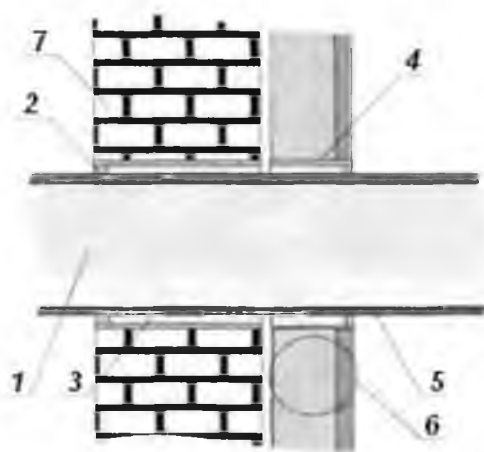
Ділянки з жорсткими повітропроводами: 1 – вентиляційний канал; 2 – віброакустичний силіконовий герметик; 3 – негорюча пружна прокладка; 4 – гільза; 5 – віброізолюючий матеріал; 6 – звукоізоляційне, або звуковбирне облицювання; 7 – стіна або перегородка.
